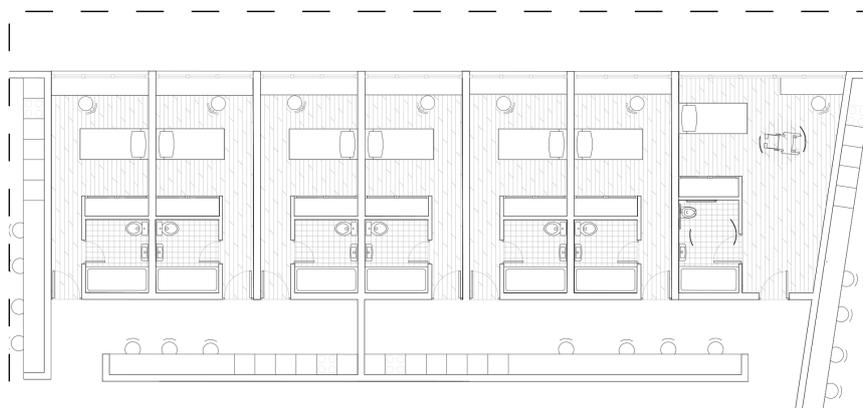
Plano detallado de 6 habitaciones estándar y una adaptada. Elaboración propia
